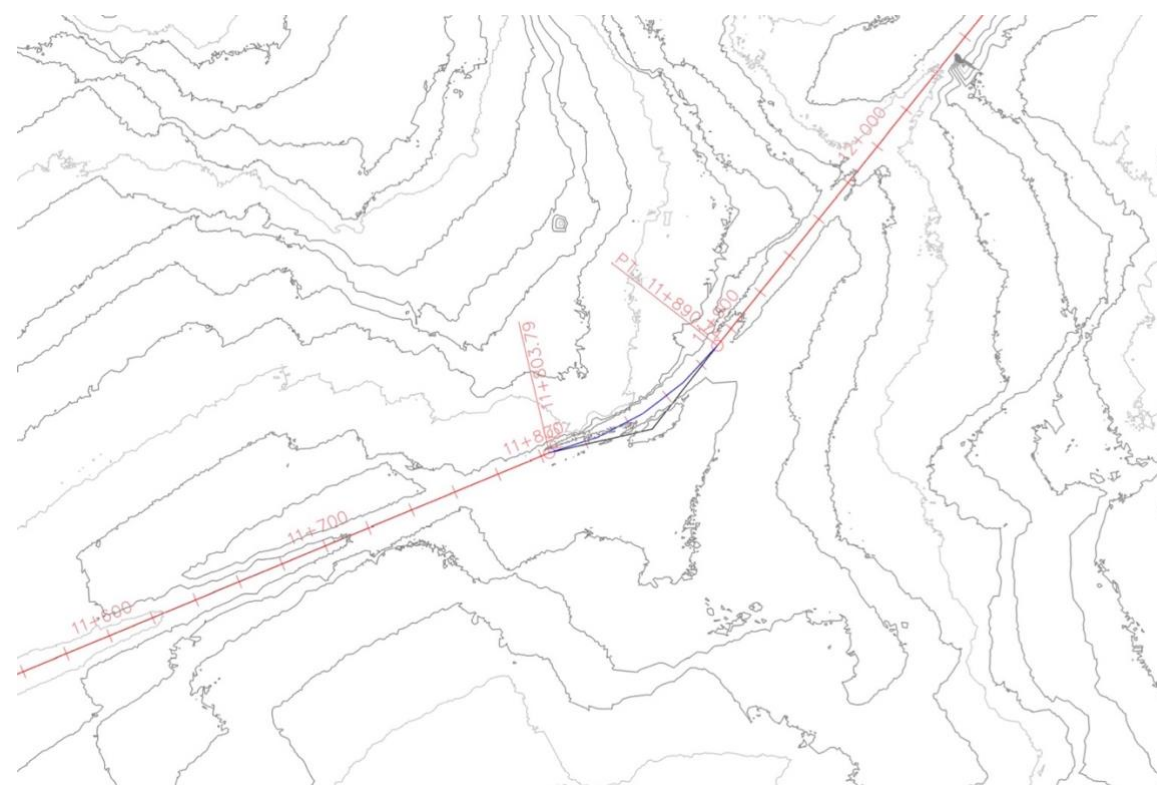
Pantallazo de Civil 3D con niveles del terreno y trazado de la carretera en planta (Curva 1)
